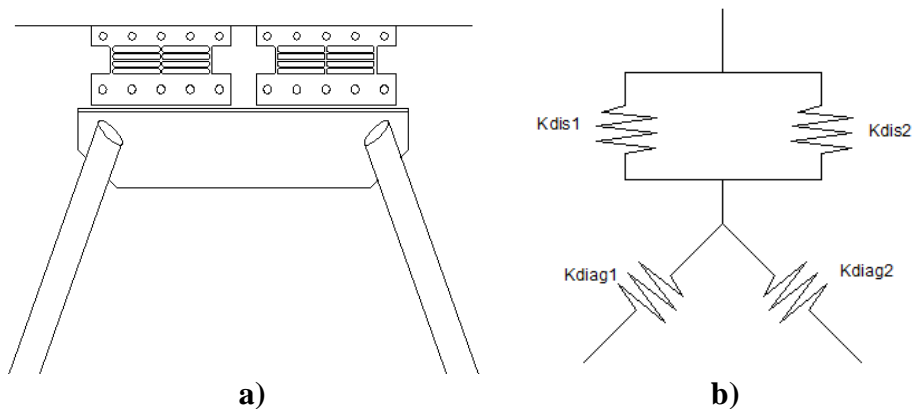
Pórtico reforzado a) Estructura; b) Modelo matemático.
